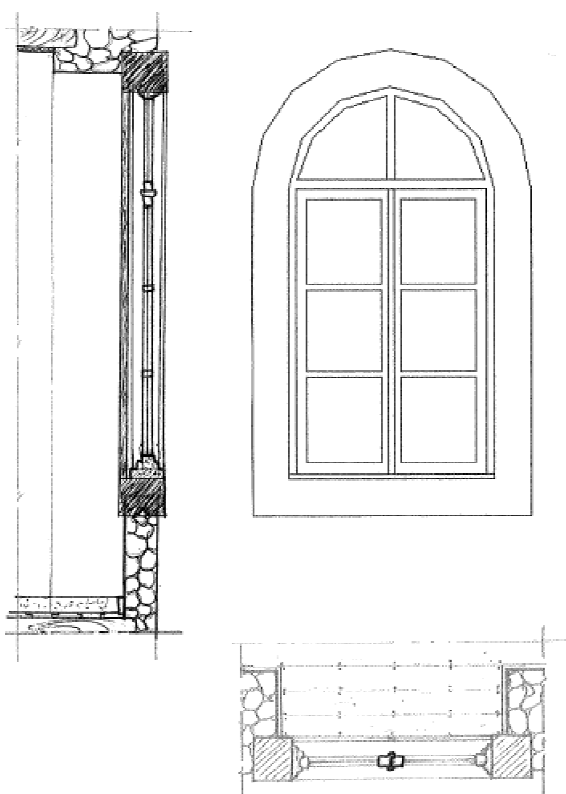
Caixilharia em madeira de uma janela de sacada e batente (duas folhas e bandeira fixa), com verga em arco pleno - corte vertical, corte horizontal e alçado exterior.
